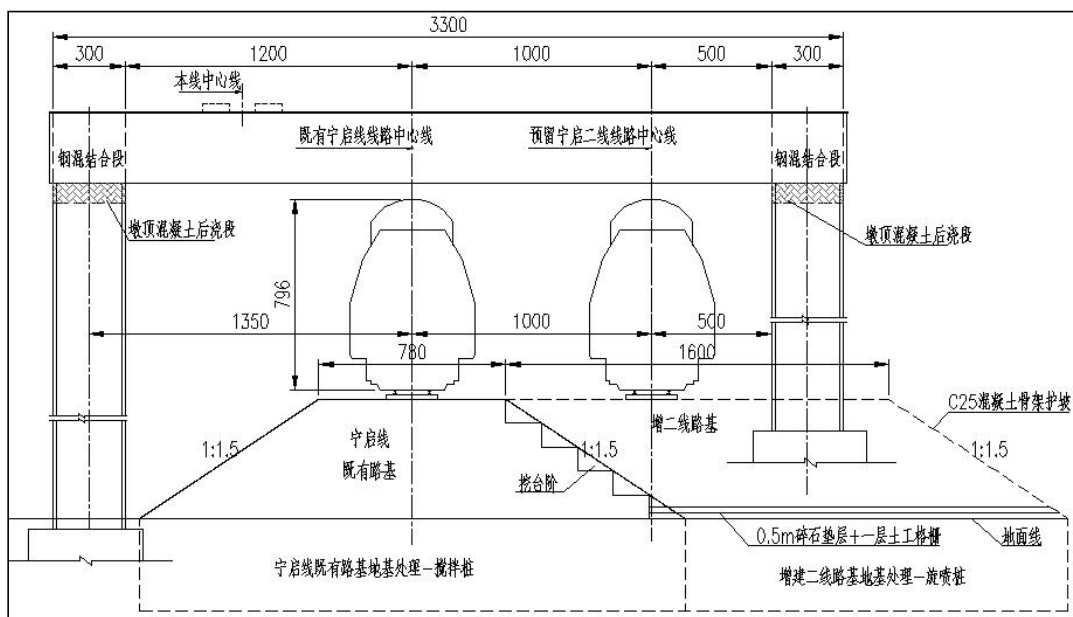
跨宁启铁路门式墩布置图 (单位: cm)
